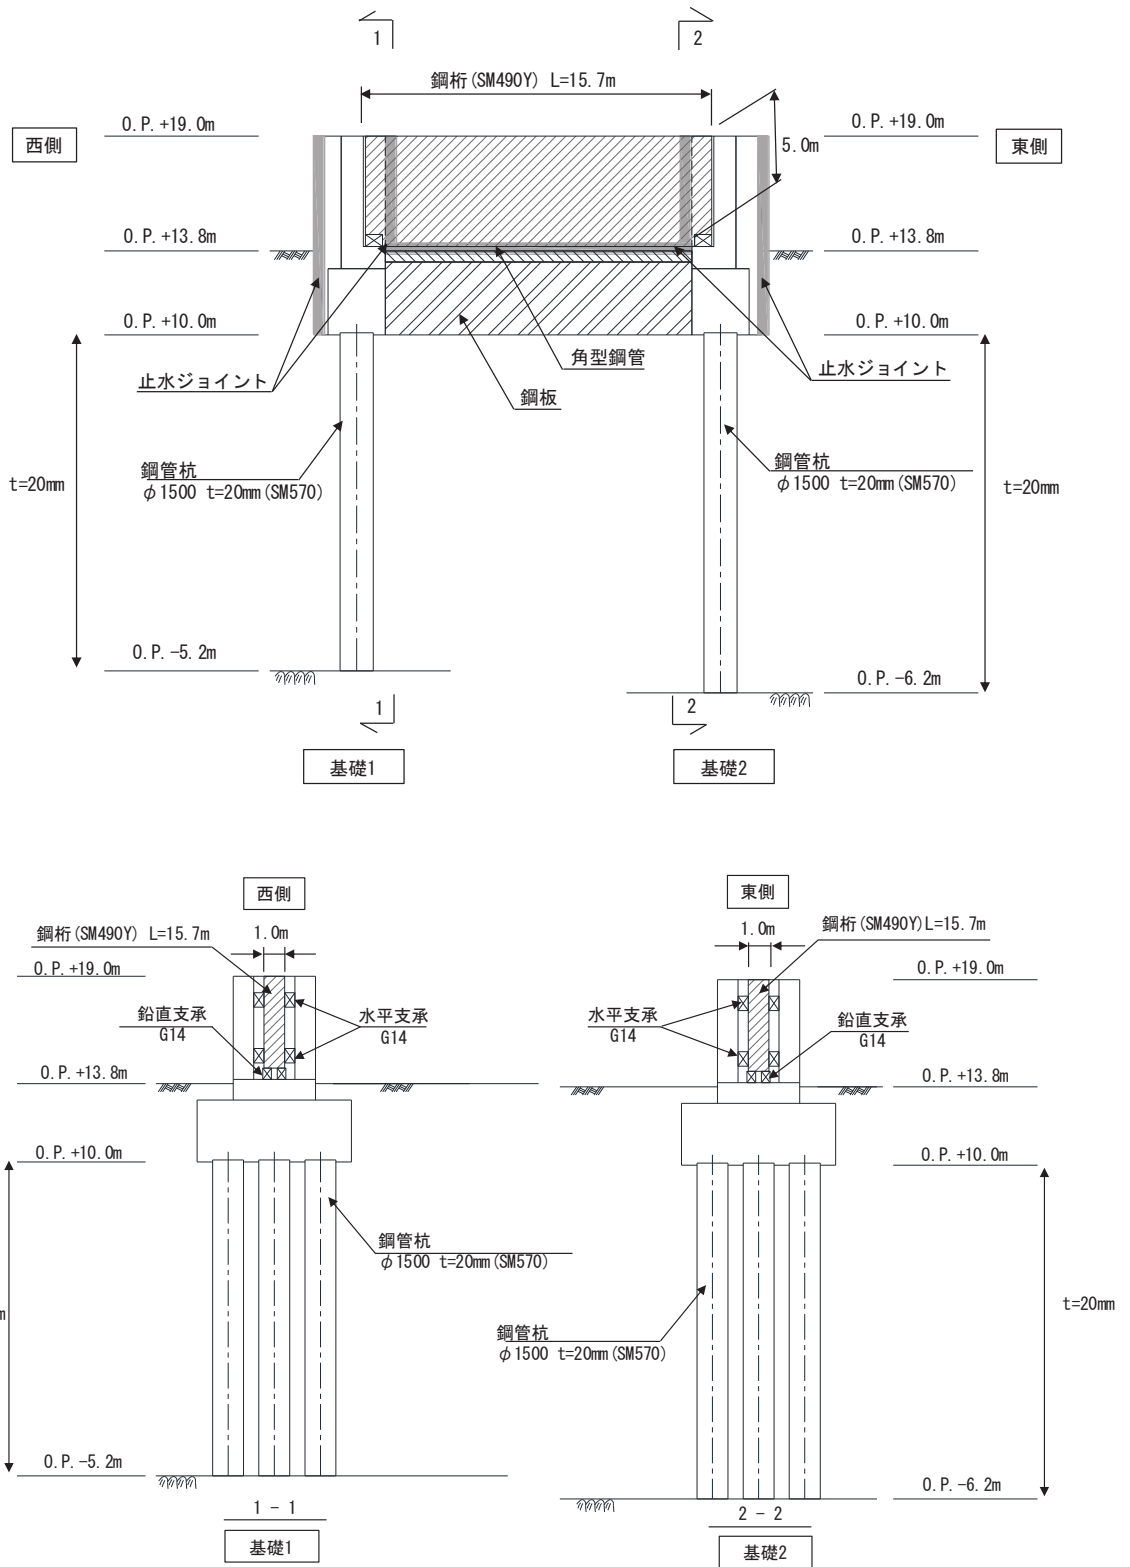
鋼製遮水壁 (鋼桁 3) 正面図及び断面図
